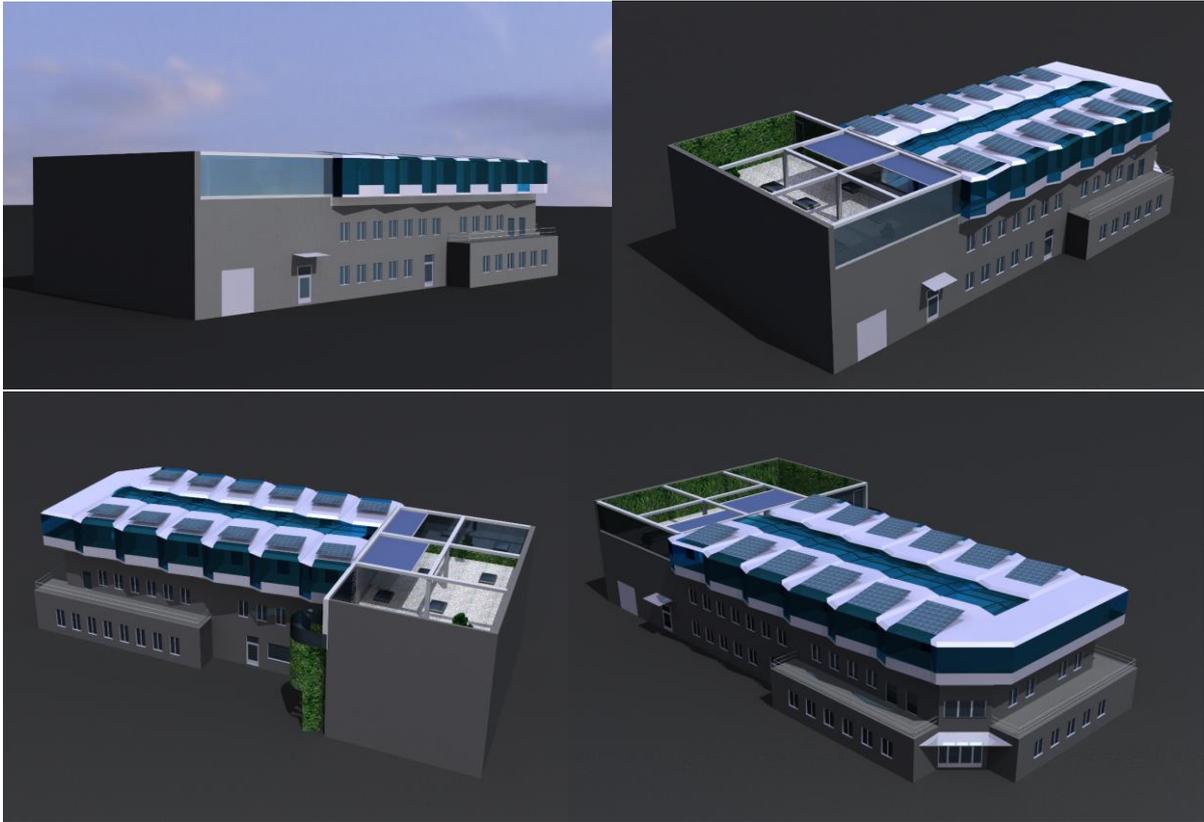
Dimension und Maße 12 Stück Containerversion 16012017 Frontansicht und Seitenansichten und Dachterrasse
